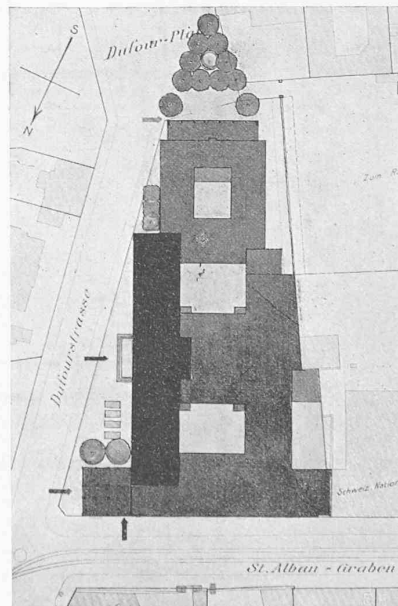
Lageplan (1 : 2000) zum Entwurf 1929.
